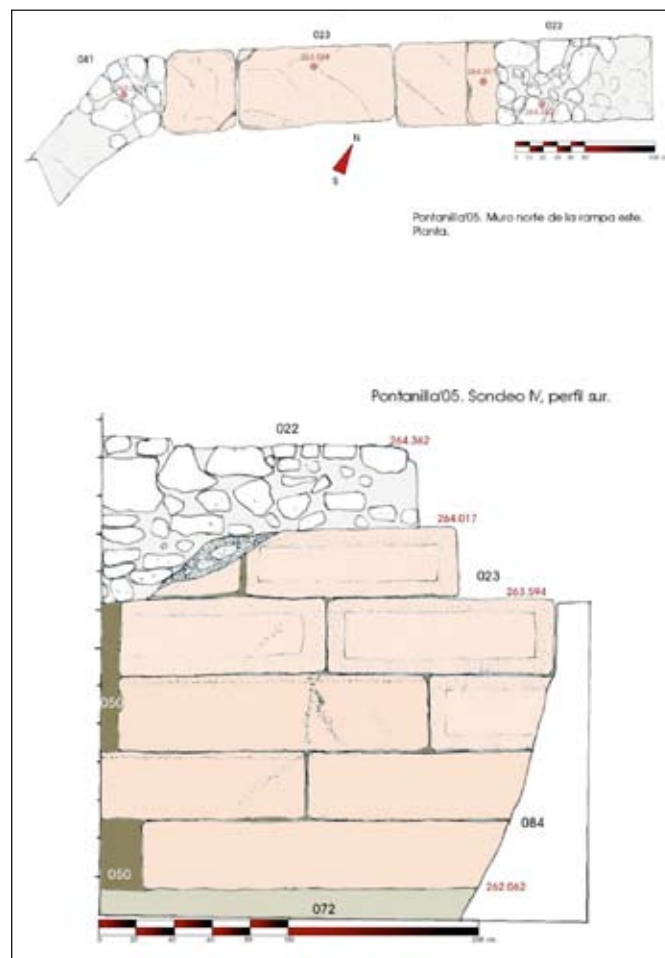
Planta y perfil del muro norte de la rampa este del puente.
